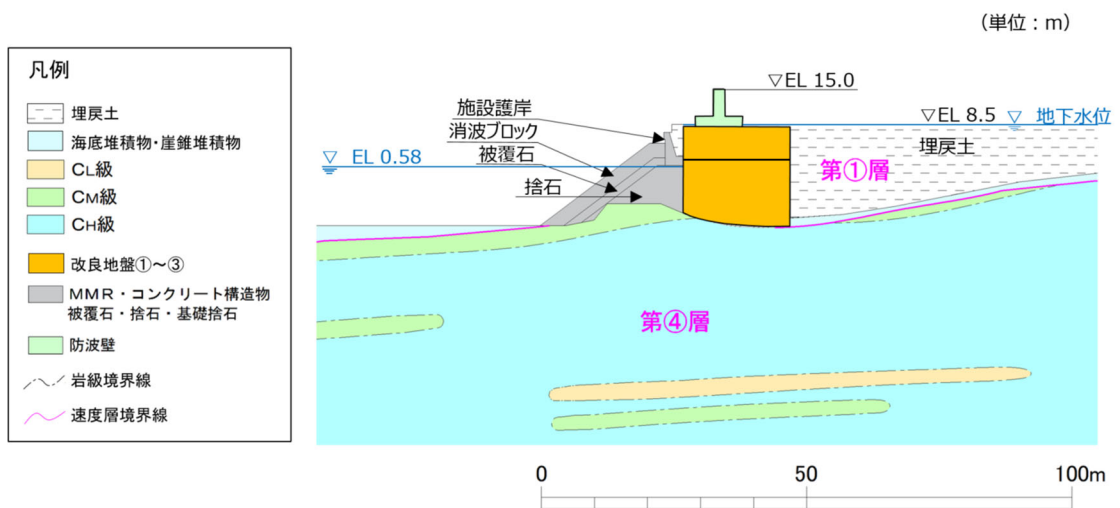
評価対象断面（⑤-⑤断面）
